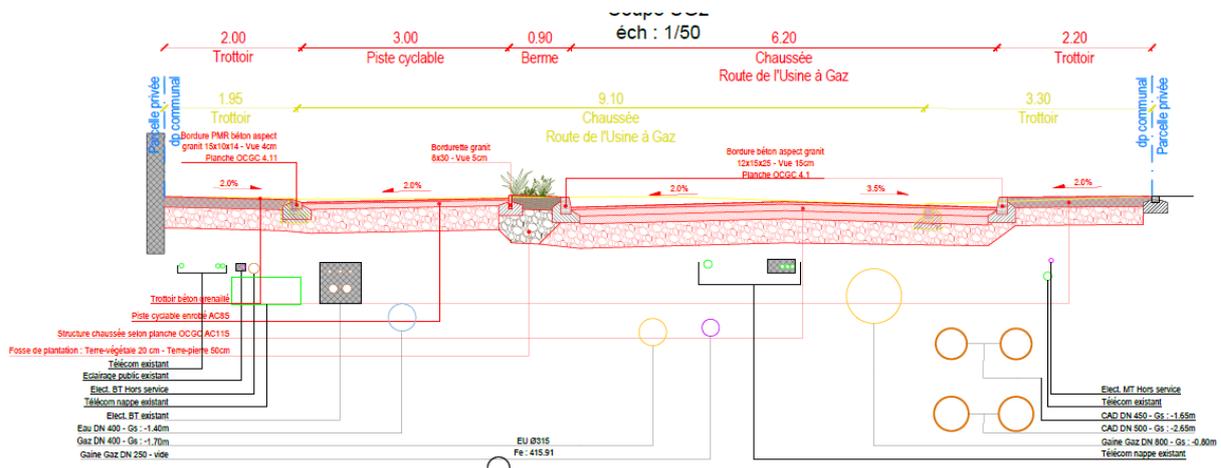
coupe sur la route de l'Usine-à-Gaz
